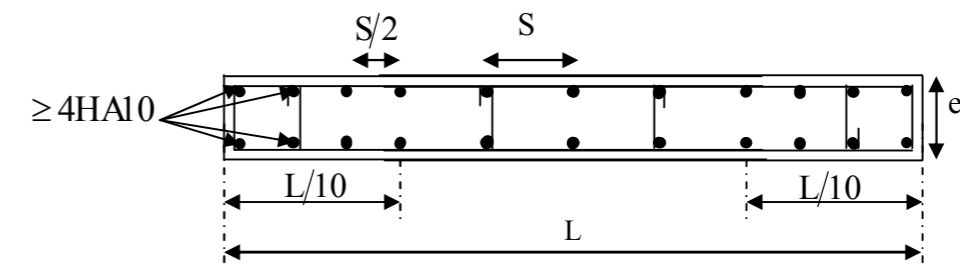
Disposition des armatures verticales dans les voiles
